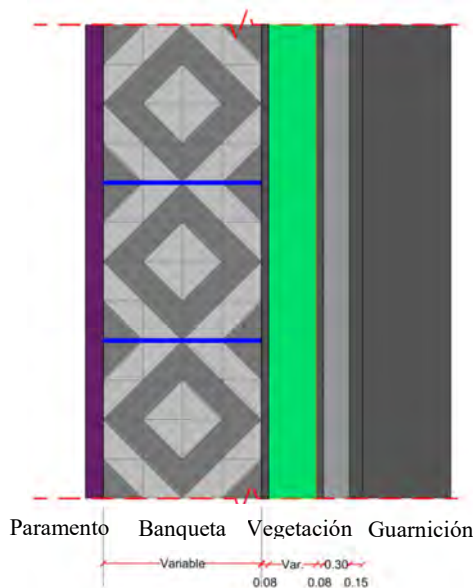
6 Planta de acabado de piso de concreto arquitectónico para banqueta.
